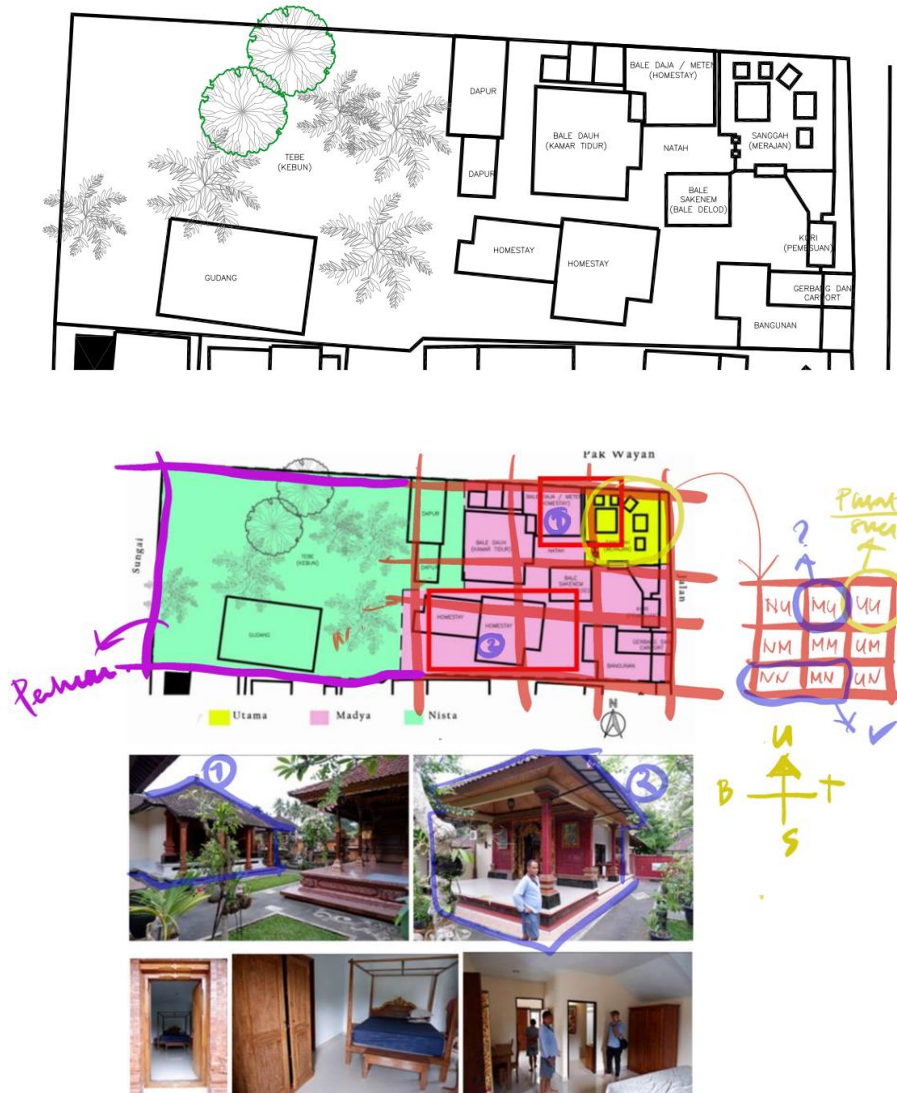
Blok Plan Eksisting Rumah Sample C milik Pak Wayan Arjana
